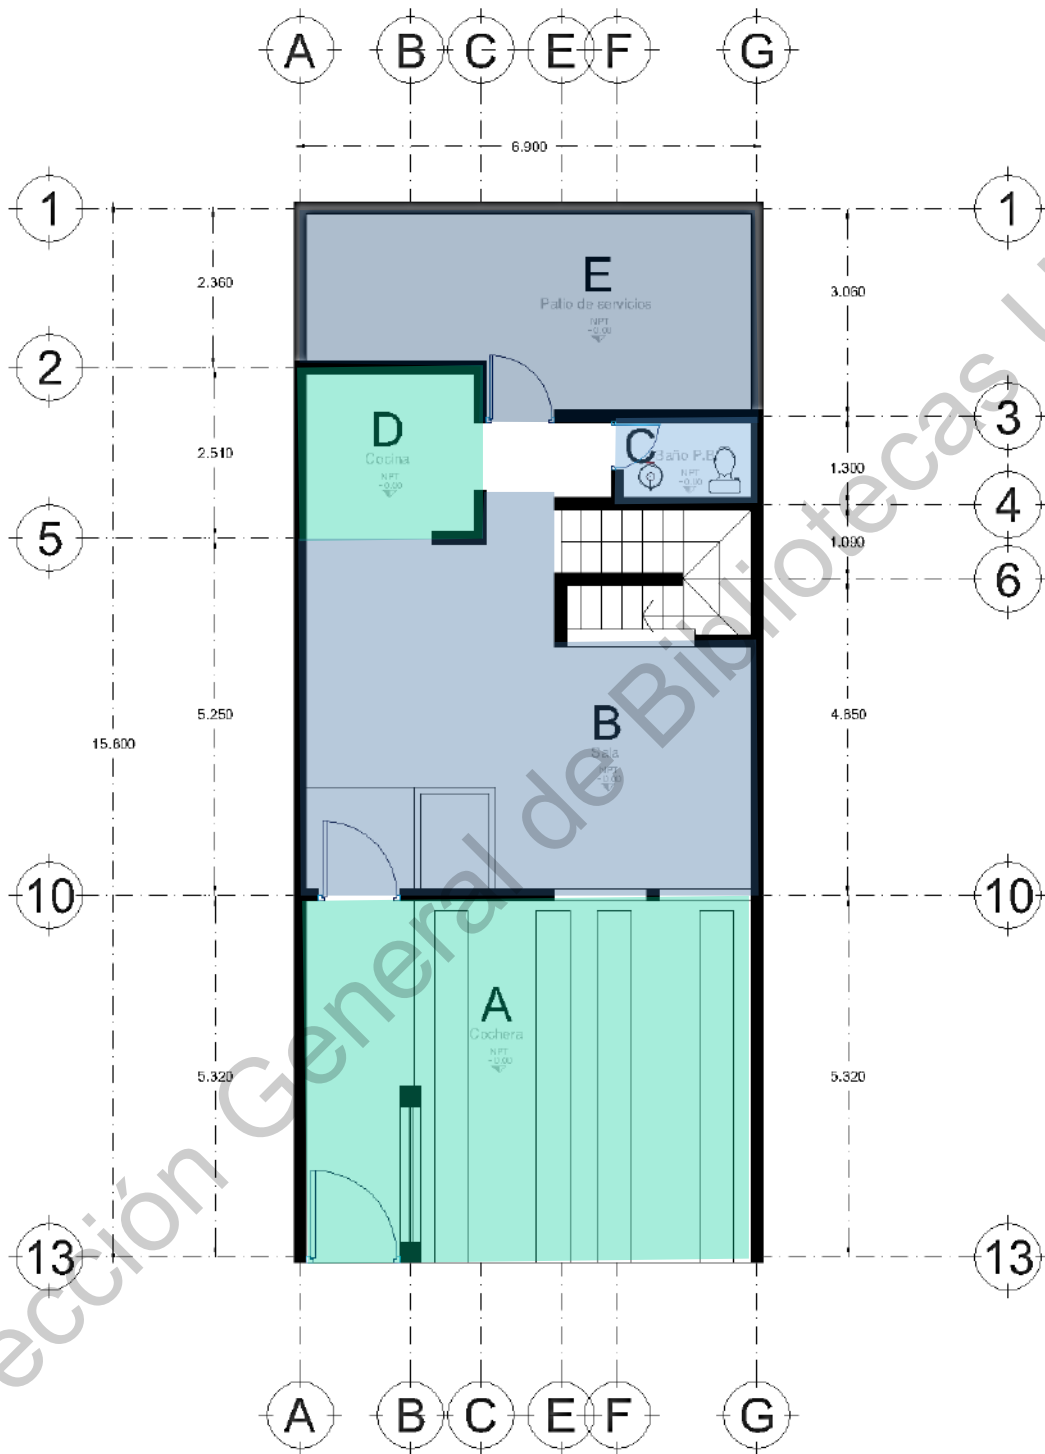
Planta Baja Casa Ixtlán. Zonificación Ecotect
